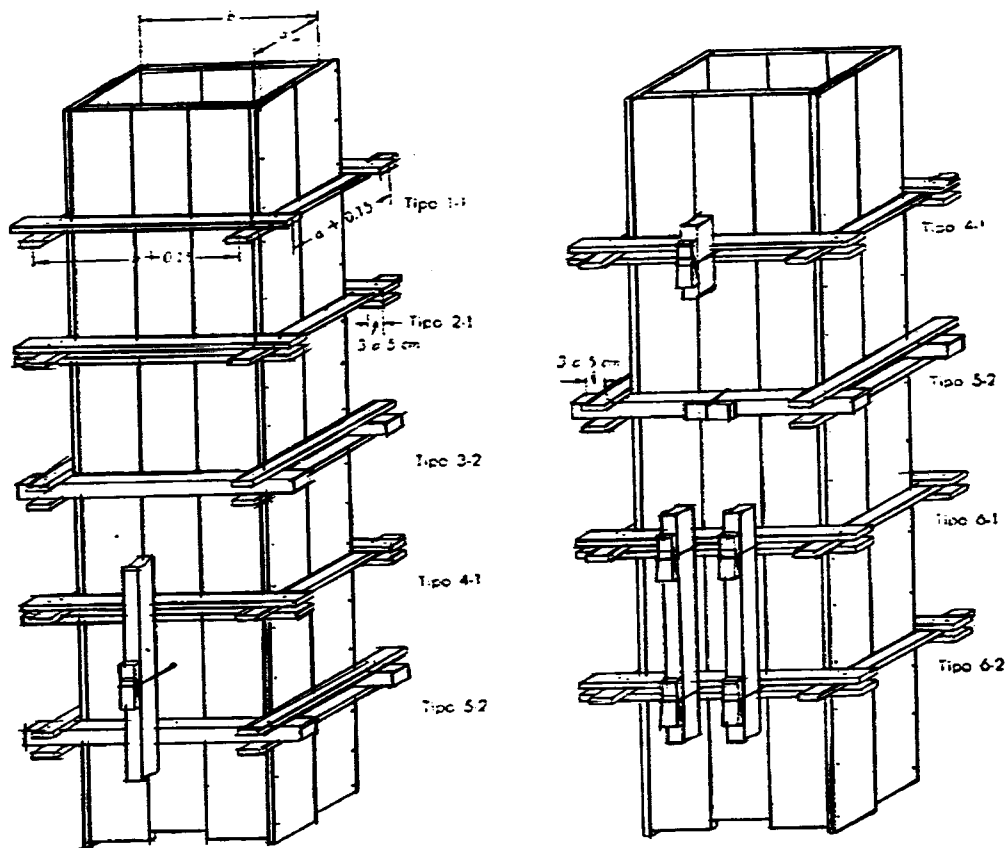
Painéis de pilares e gravatas para amarração (Fonte: ABCP, 1943).
